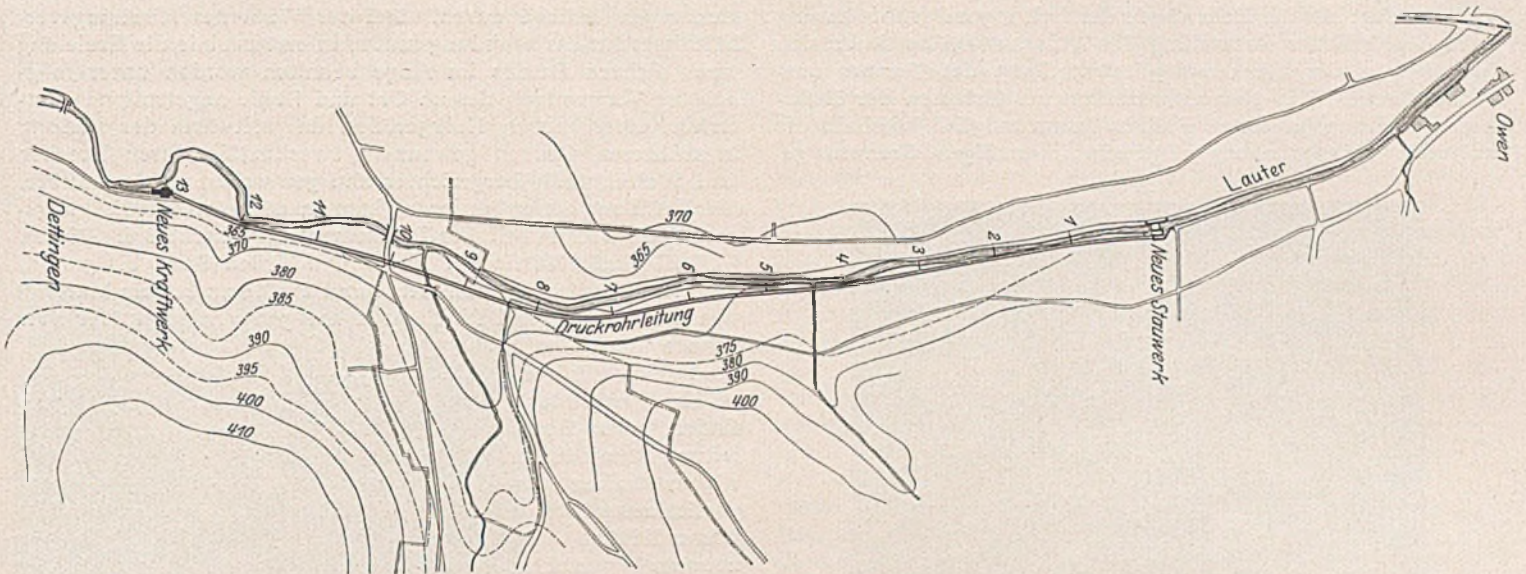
Lageplan der Druckrohrleitung Owen—Dettingen.
